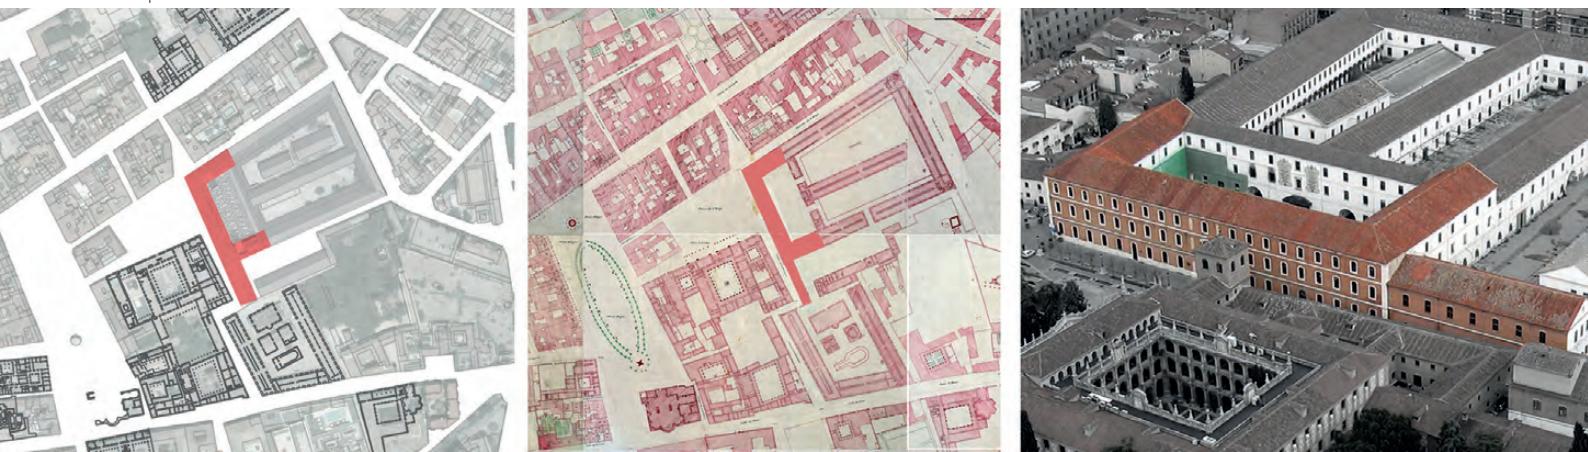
Plano de situación, plano histórico s.XIX y vista del cuartel antes de la intervención / Figure 2. Site plan, historic plan XIX century and barrack view before intervention.
